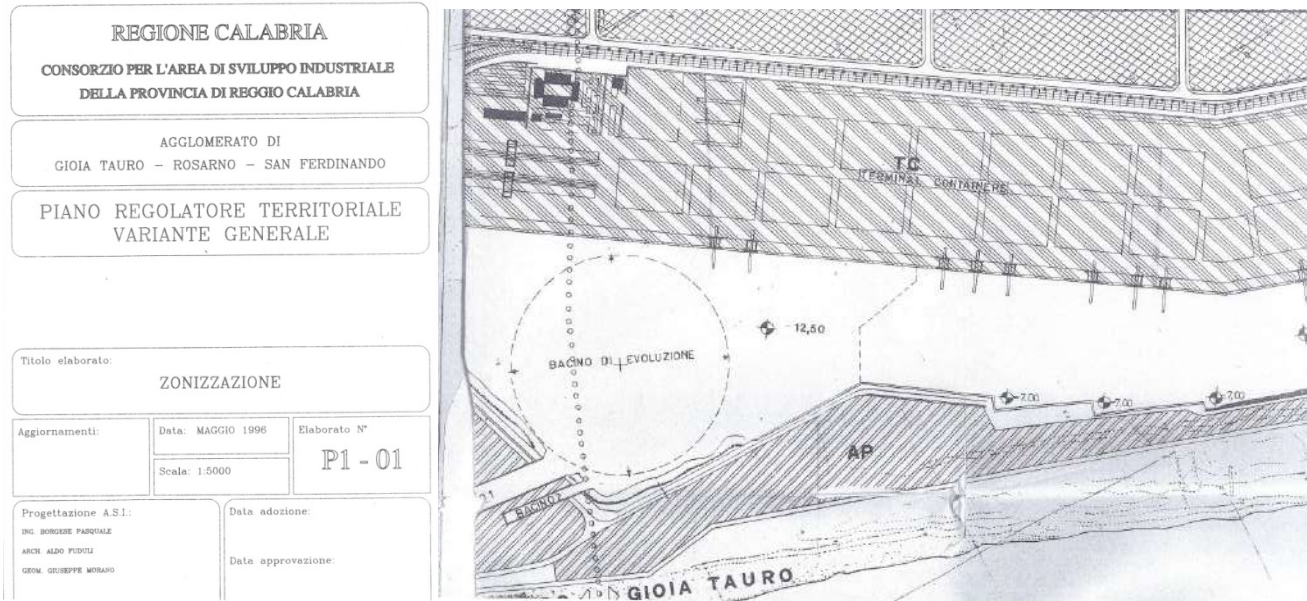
Stralcio di PRT approvato nel 1997 inerente le banchine di progetto
